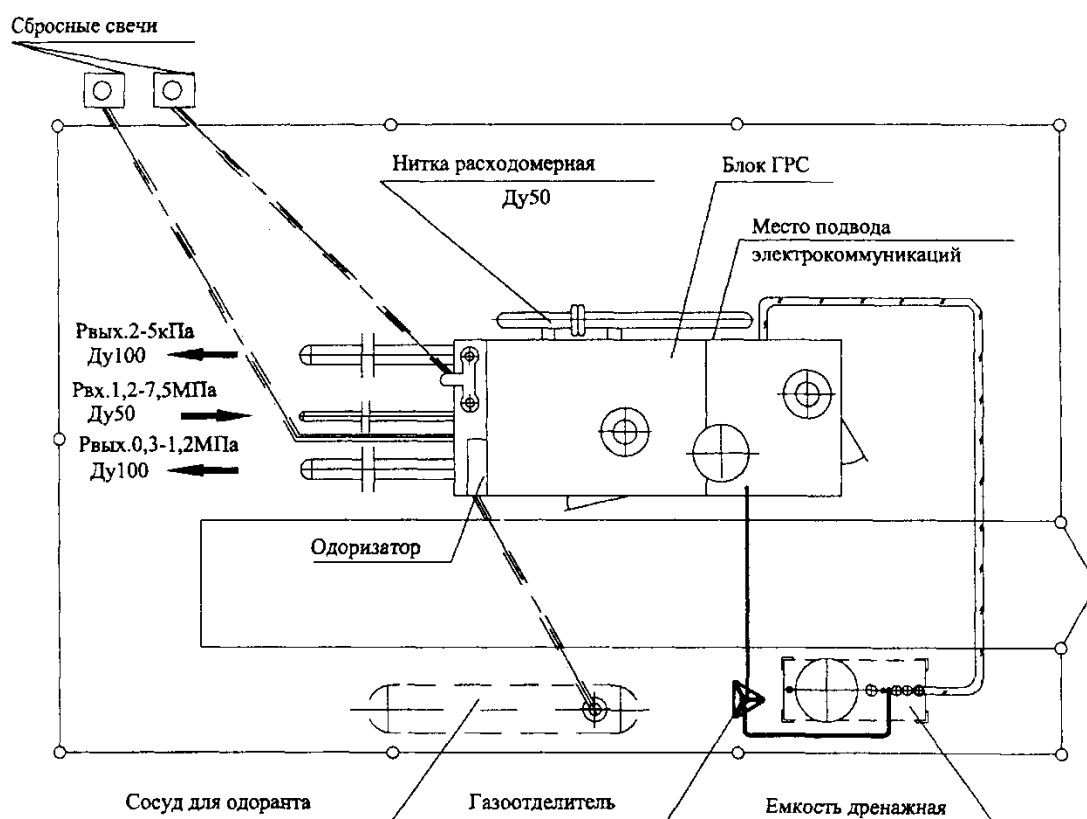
Схема размещения блоков станции "САРАТОВ-1" на площадке
